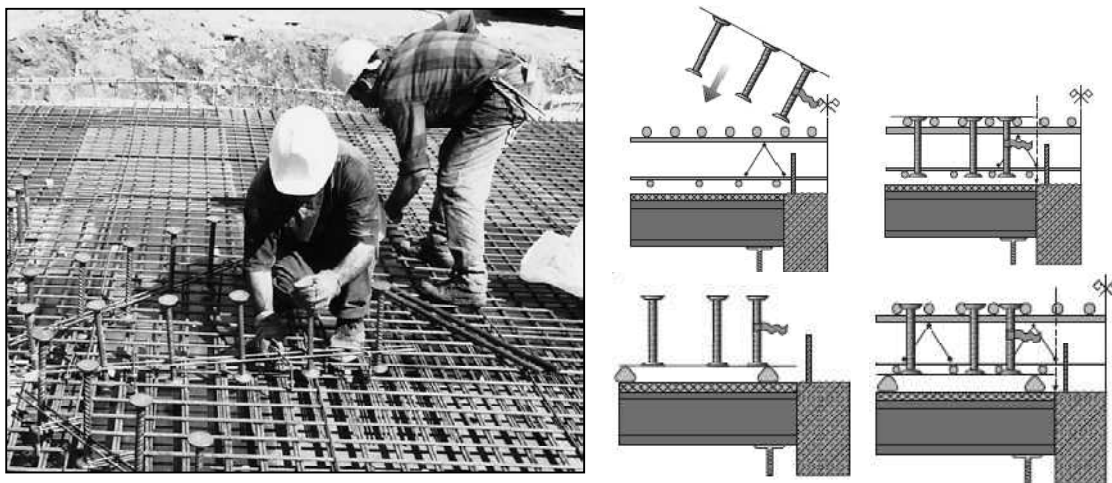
Detalhes do sistema de armaduras SCHÖCK BOLE
